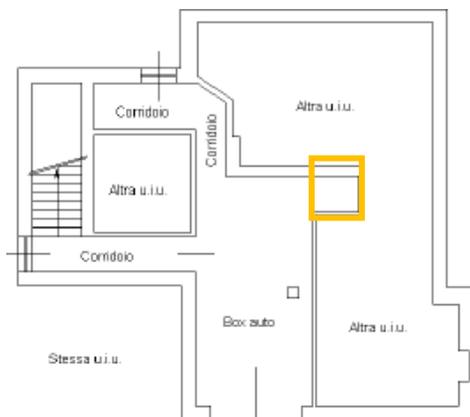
Planimetria Sub. 5 (attuale reperita dal CTU) con l'individuazione della porzione indebitamente incorporata nel sub. 16 (già Sub. 6)
